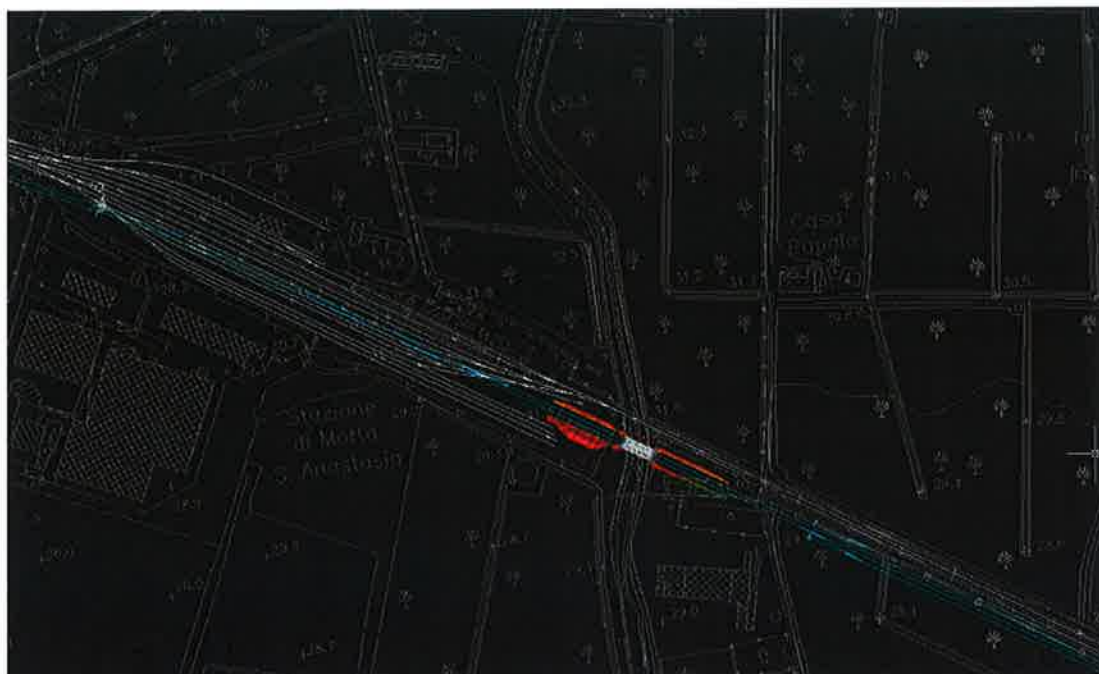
Stralcio planimetrico del nuovo tracciato ferroviario – Torrente Finaita.
